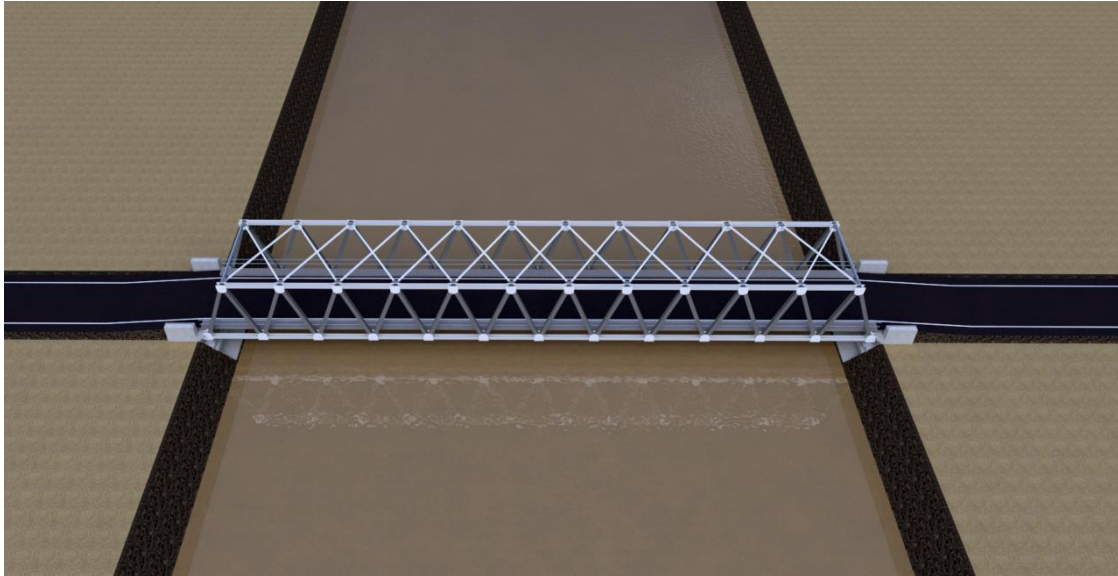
Konstruksi jembatan rangka baja
